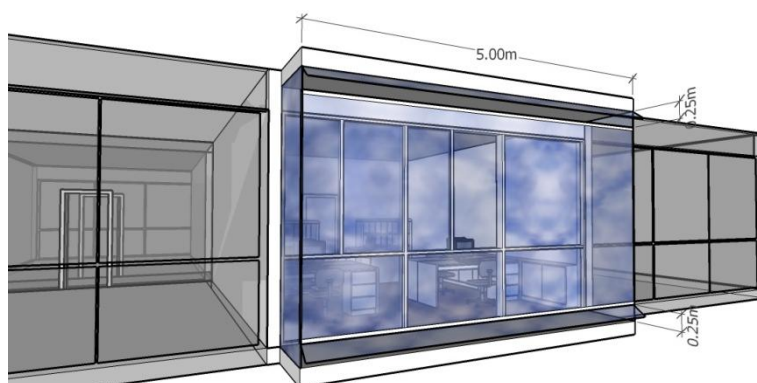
Dimensões e funcionamento das aberturas da fachada dupla ventilada.
